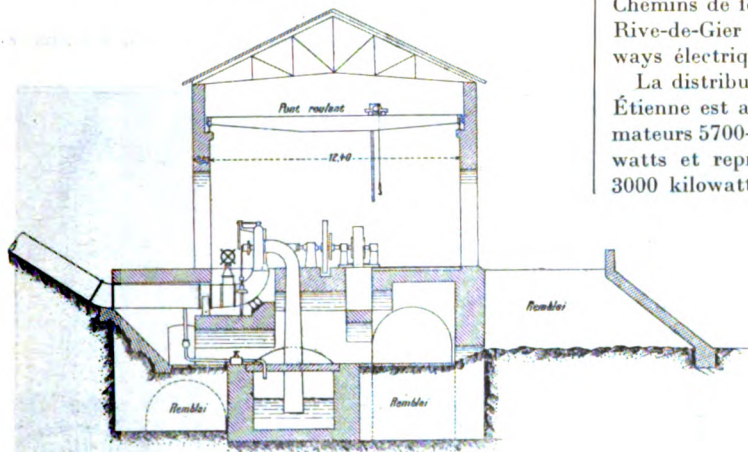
Coupe transversale de l'usine de Château-du-Lignon.
